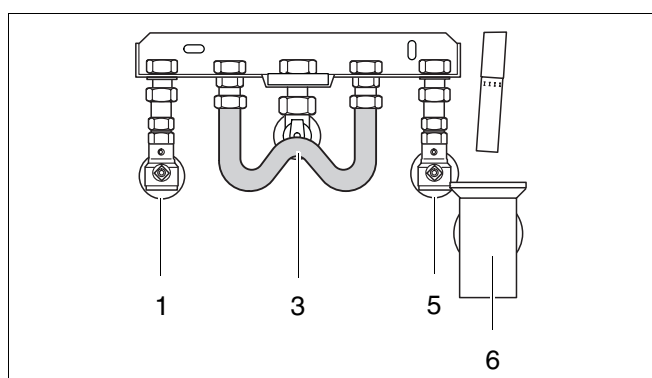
Rohranschlüsse Unterputzmontage mit Kurzschlussleitung
